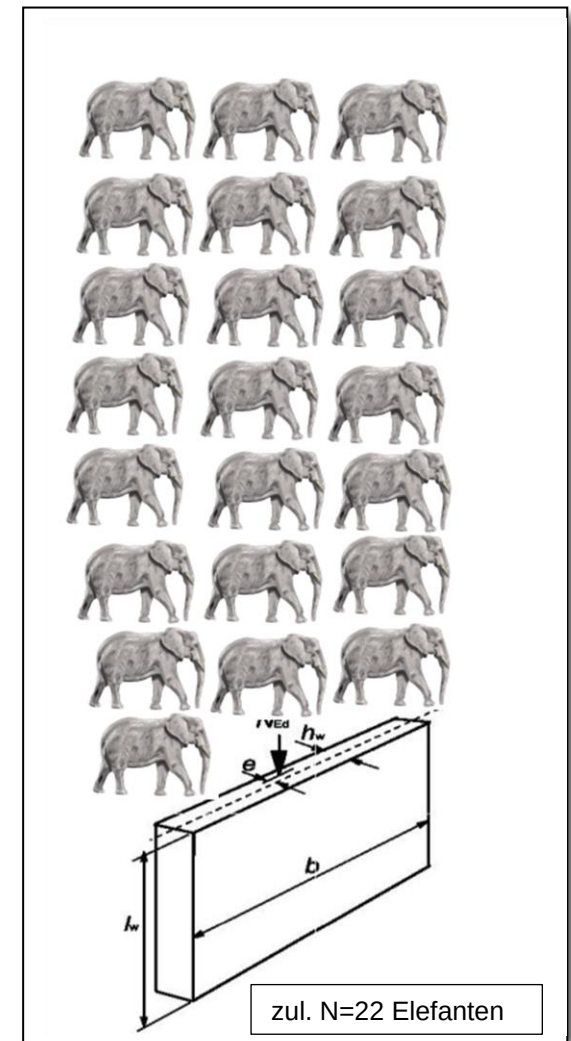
, Tragfähigkeit unbewehrte Betonstütze
